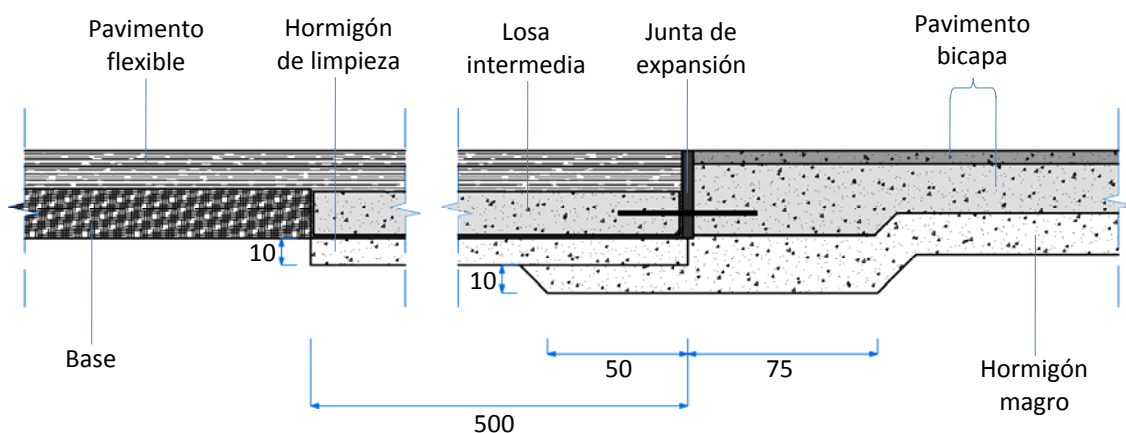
Transición de un pavimento bicapa de hormigón a un pavimento flexible
